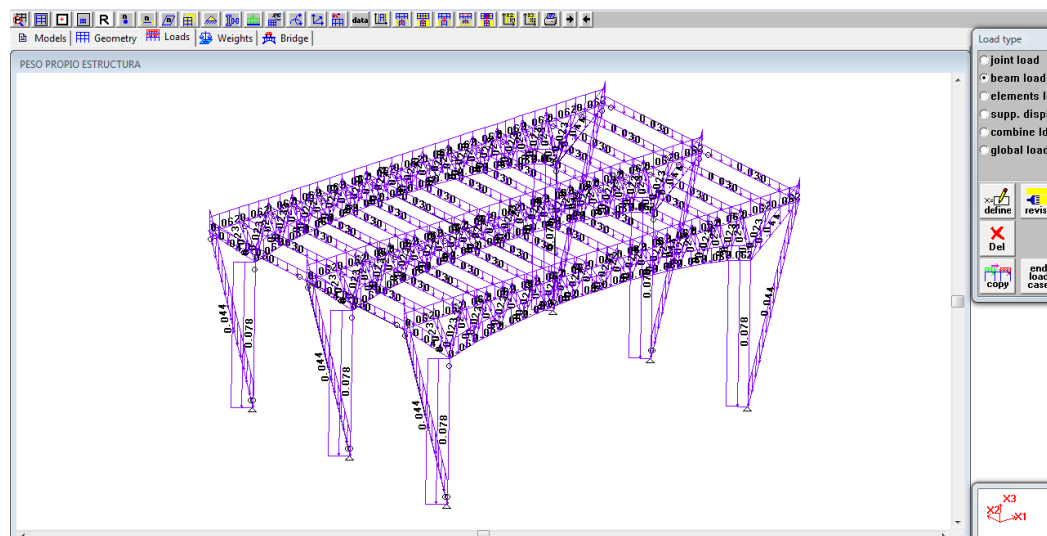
Estado de cargas 1: PESO PROPIO ESTRUCTURA
